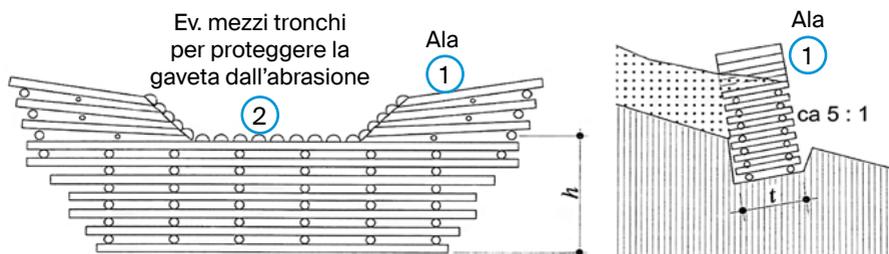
Briglia con cassoni a due pareti in legno: prospetto e sezione (USTRA)
